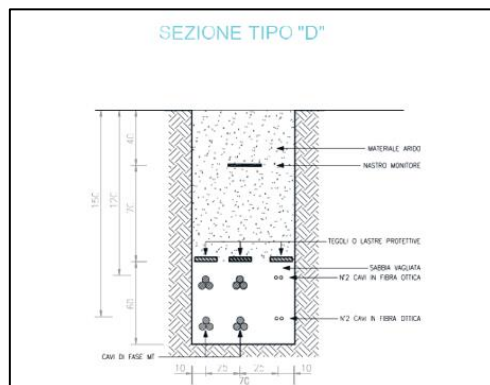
Sezione tipica di posa della linea in cavo su strade sterrate
